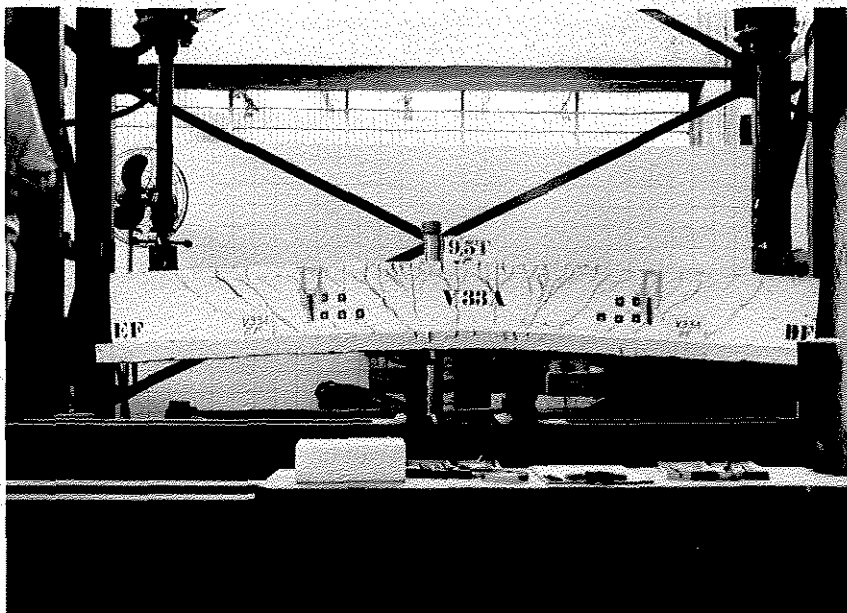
Vista geral do ensaio da viga V40A = V33A.
